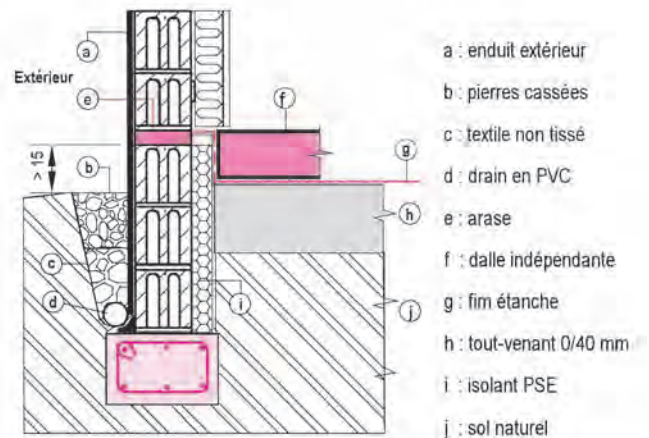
Dalle en béton armé indépendante du mur de rive
